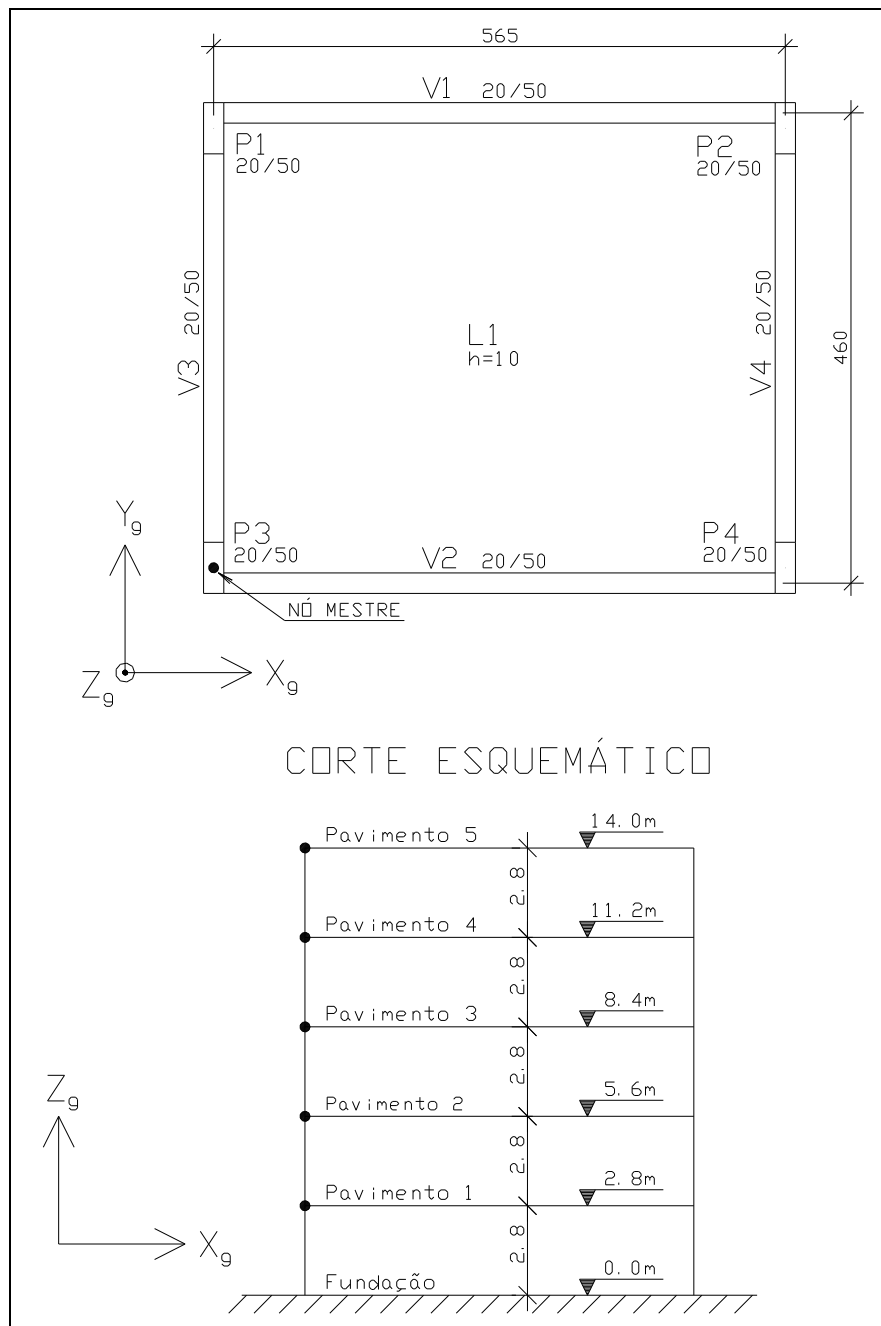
planta baixa do pavimento tipo e corte esquemático – exemplo 1
